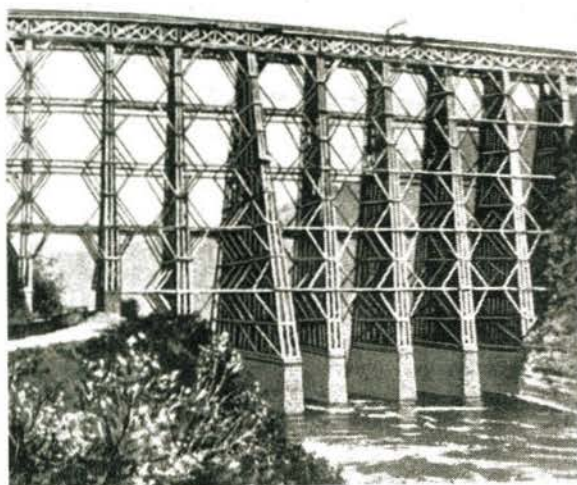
Holzgerüste als Unterbau in Amerika (trestle works)
